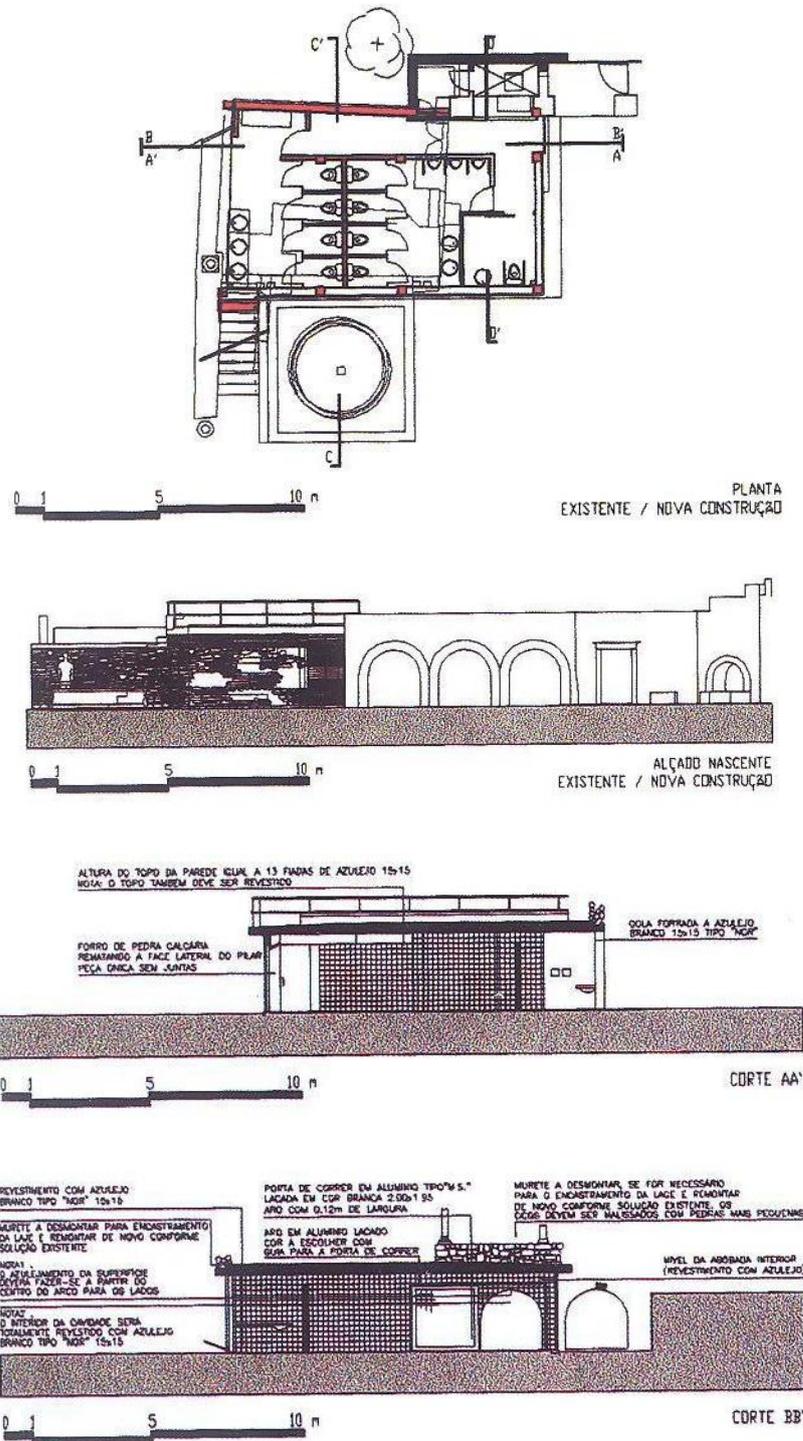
Planta existente/Nova construção (Architècti, 2000, p.49).
